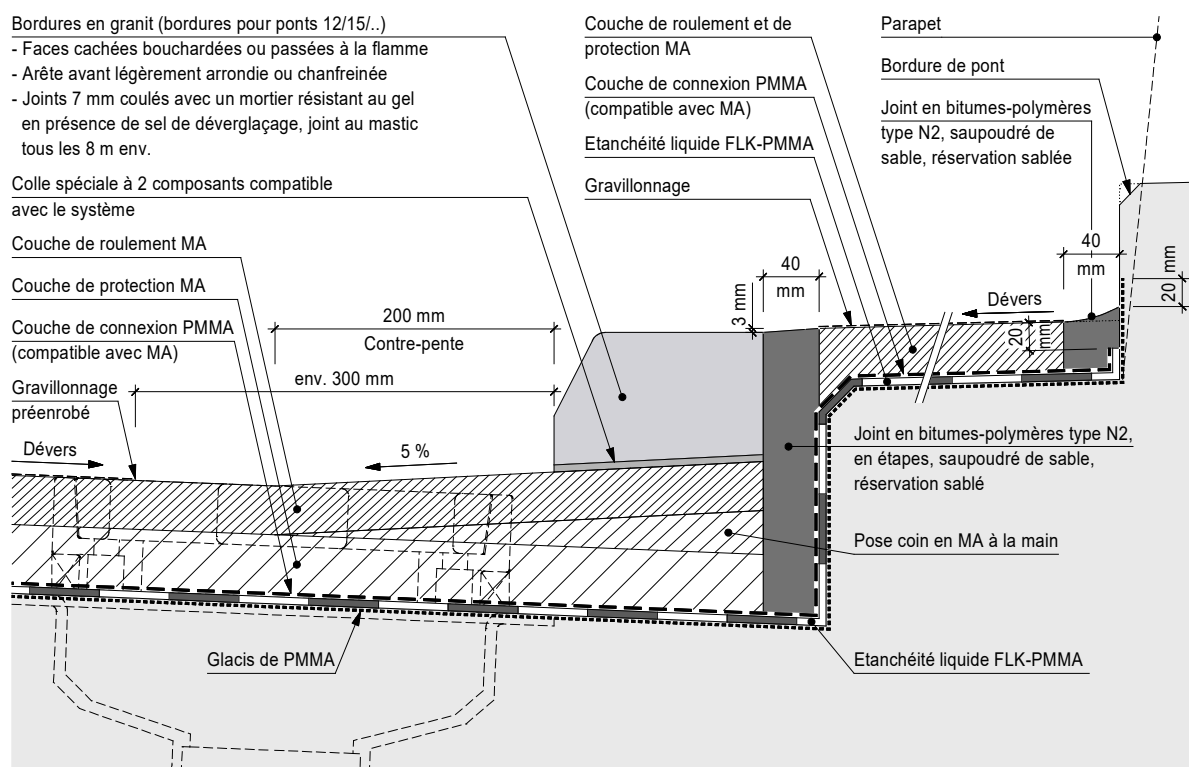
Système d'étanchéité FLK - Raccord aux trottoirs - Bordure de trottoir collée - Point bas
